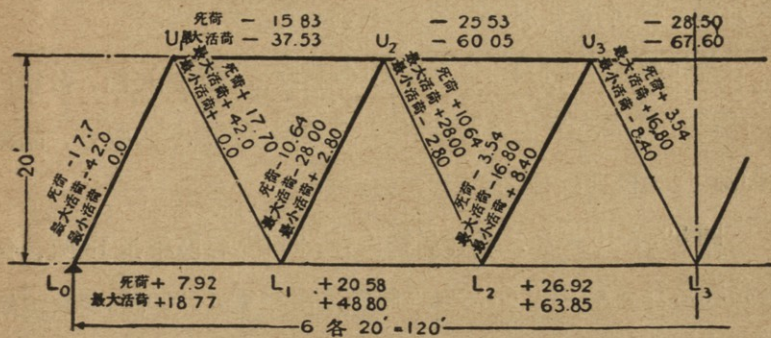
窩楞構架半面之尺度及受活荷重時之應力圖
